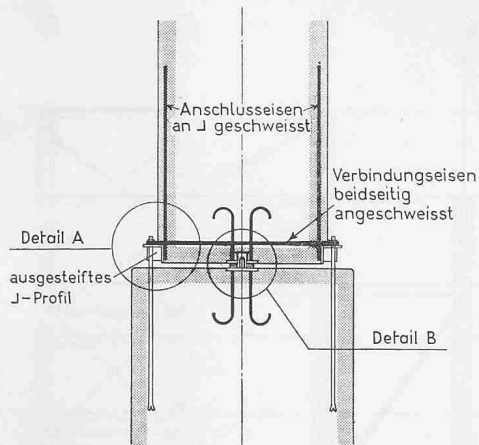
Biegesteifer Anschluss einer Erdgeschoss-Stütze an die Unterkonstruktion. Masstab 1:60
